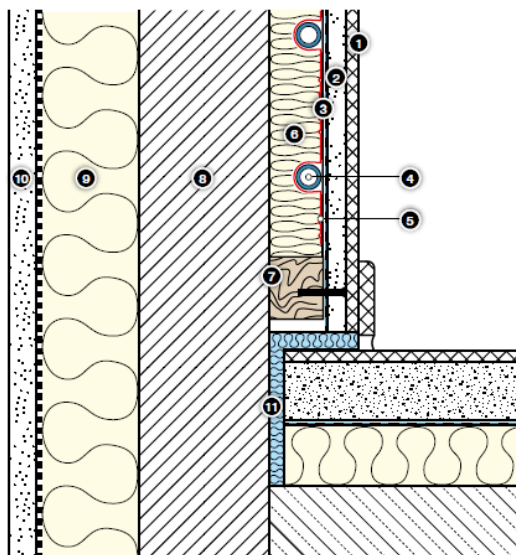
Конструкция стенового отопления Kan-therm TBS Wall (продольный разрез):
